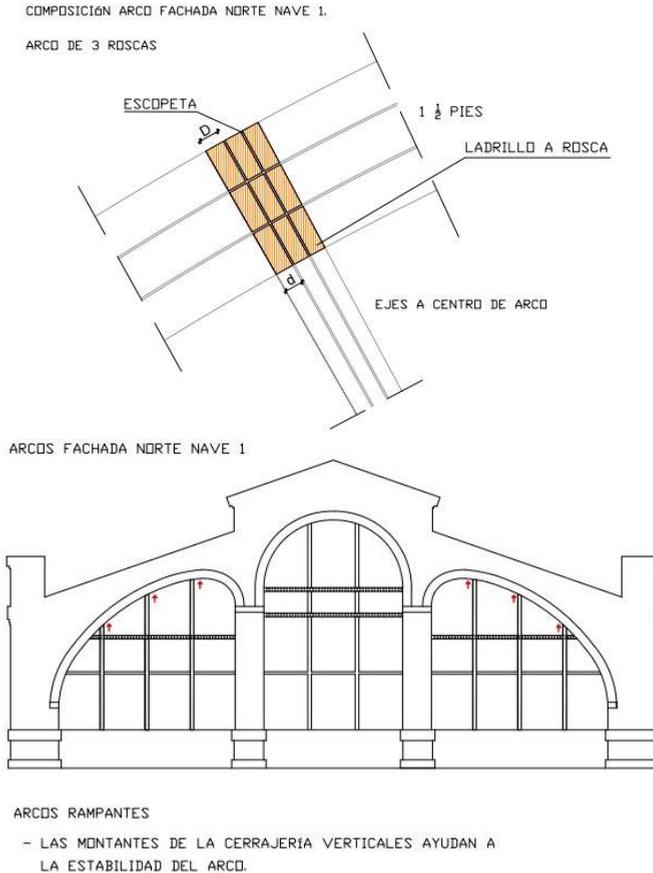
Imagen y croquis arcos fachada Norte y composición Nave 1.
